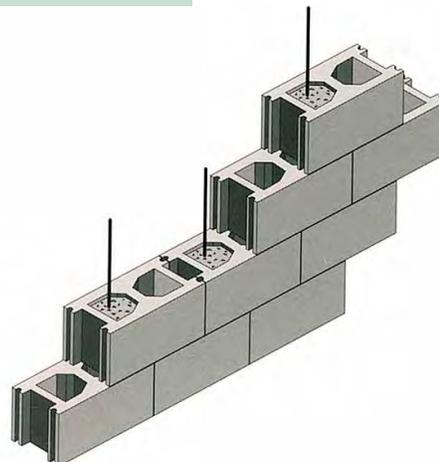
Esquema de sistema constructivo para muros con block hueco de concreto.
